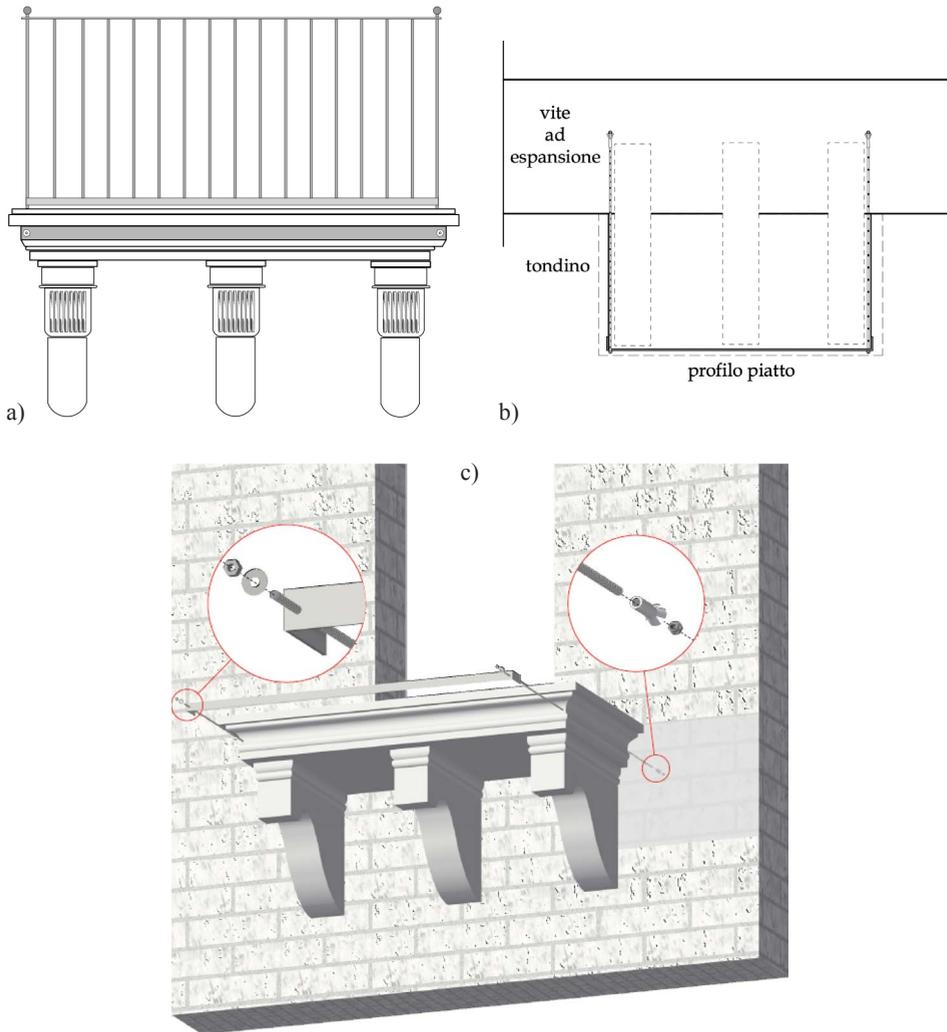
a) lastra ricomposta; b) sistema di tirantatura in pianta; c) vista prospettica con particolare del piatto di perimetro e dei tiranti.
